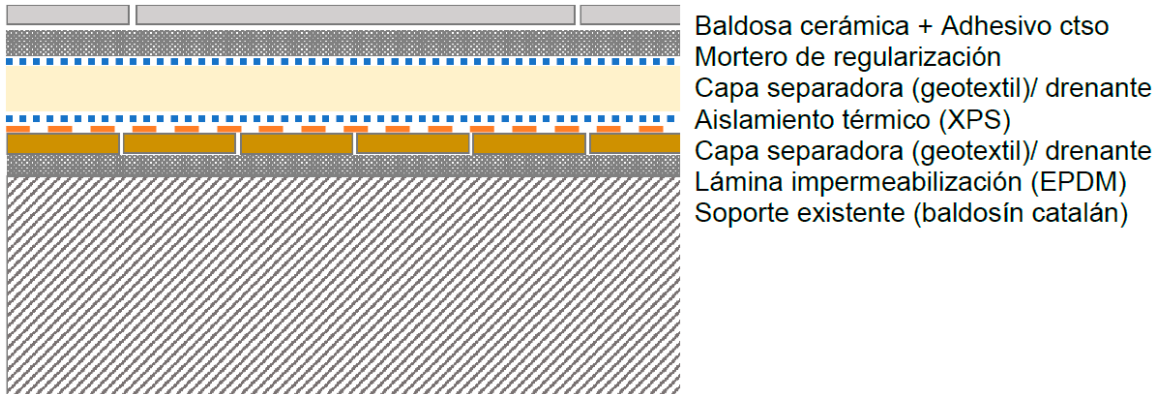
Esquema/ Componentes de la Cubierta invertida con pavimento cerámico adherido.
